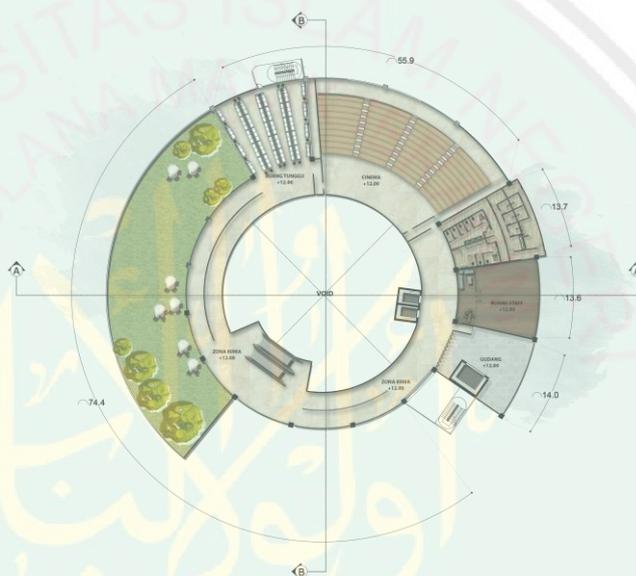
11 Denah Sains dan Teknologi Lantai 1
